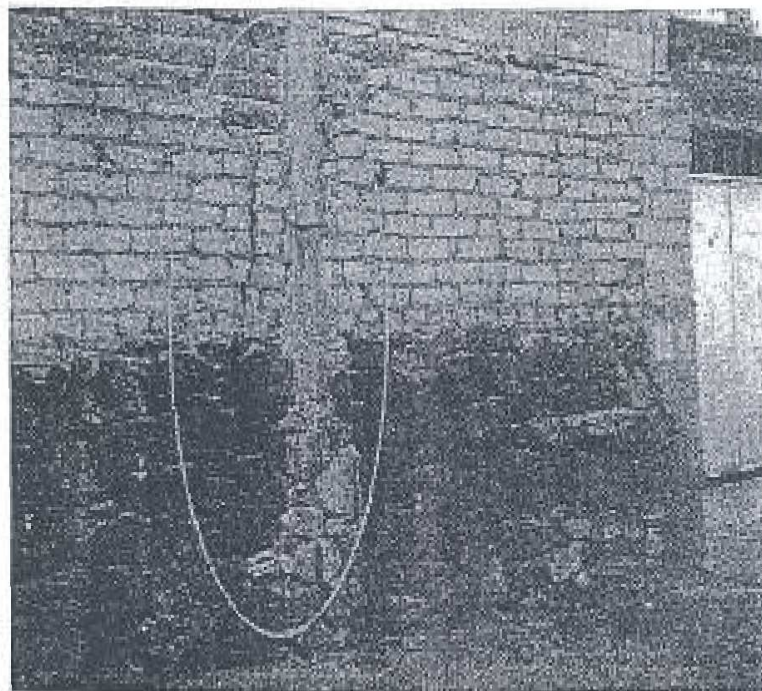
Fisura en el muro que indica el paso de una grieta.
